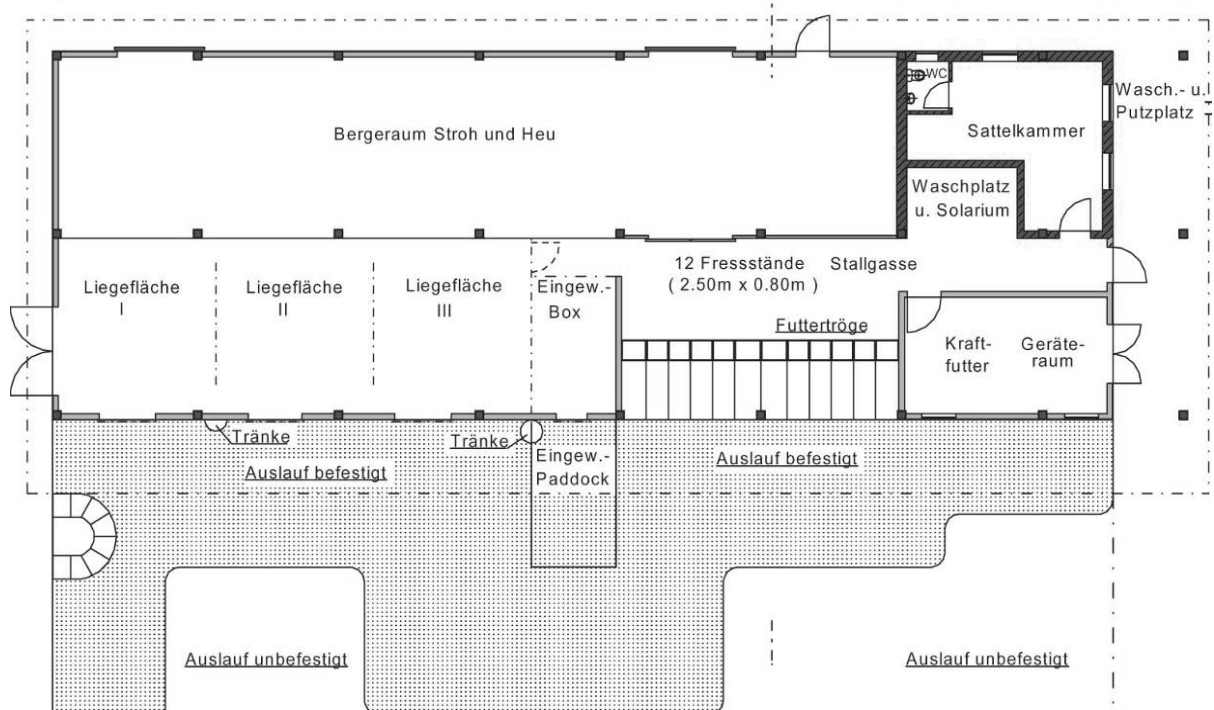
Beispiel-Grundriss einer Mehrraum-Auslaufhaltung für eine Großgruppe (nach KTBL, 2004)
